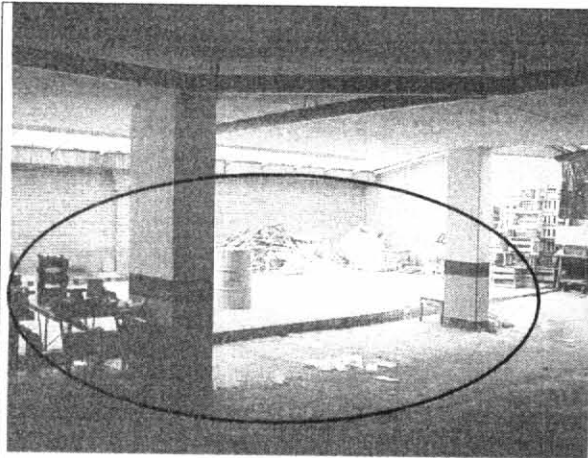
Diferencias de asentamientos entre la estructura principal y la construcción ubicada en el sector posterior.
